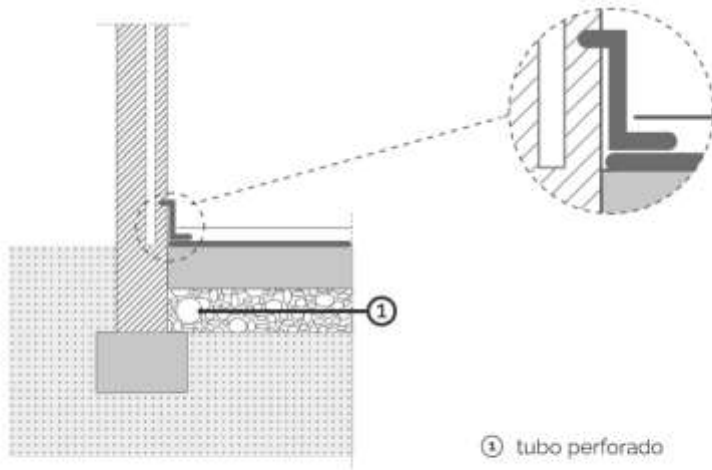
Encuentro de la barrera tipo lámina con una fachada mediante encastrado y tubo perforado
